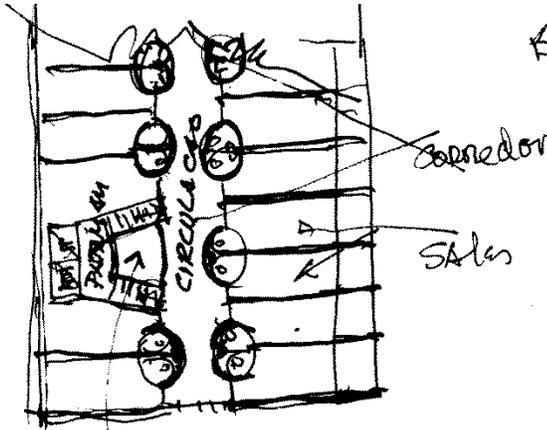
Croqui da planta com as paredes arredondadas que contém os BWCs. Fonte: Borsoi Arquitetos Associados.
